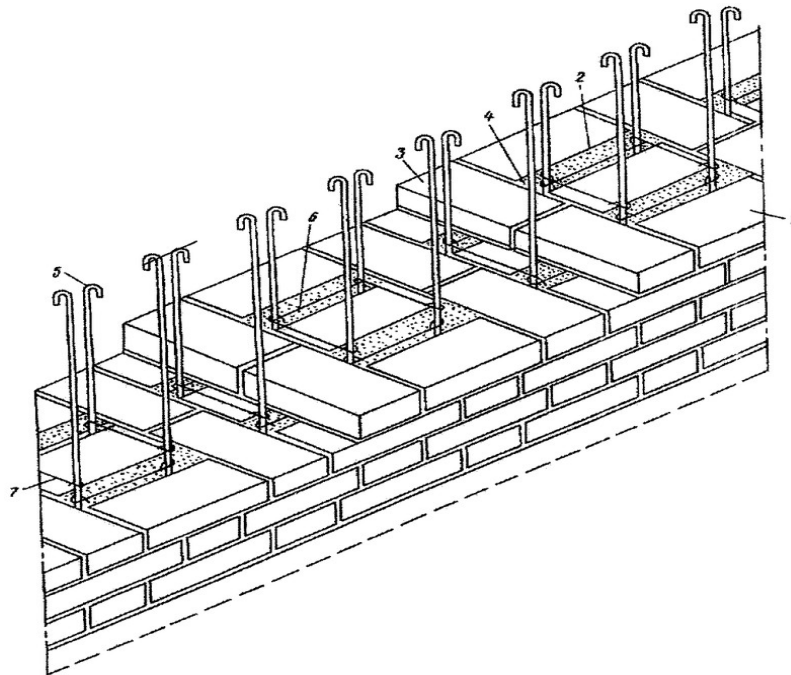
Армирование кладки вертикальными стержнями
